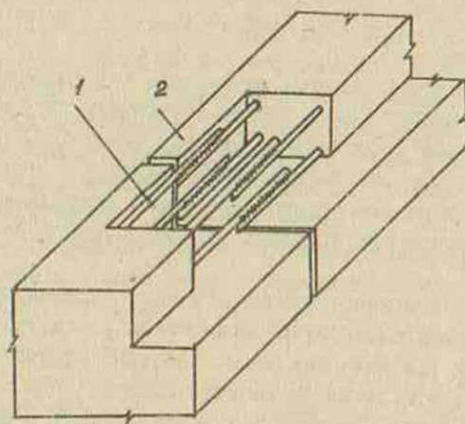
Схема устройства пояса из поясных блоков: I — выпуски арматурных стержней; 2 — блоки
